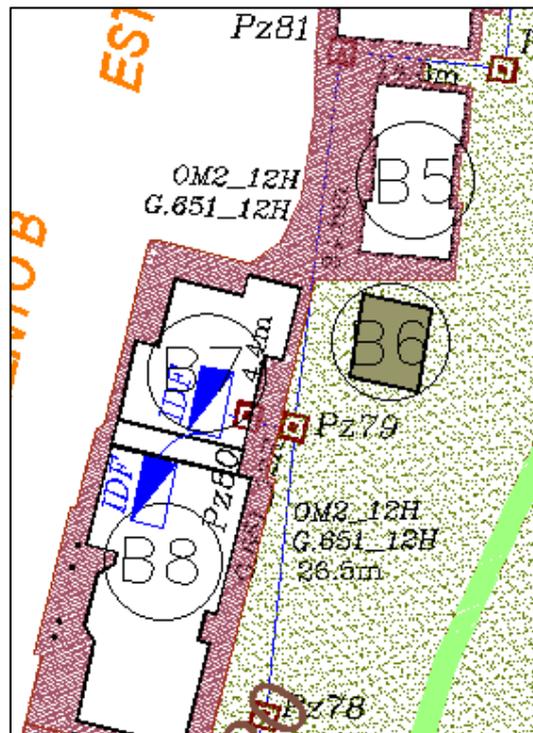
Planimetría del recorrido de fibra óptica existente bloques 7 y 8. (Autor, s.f.)
